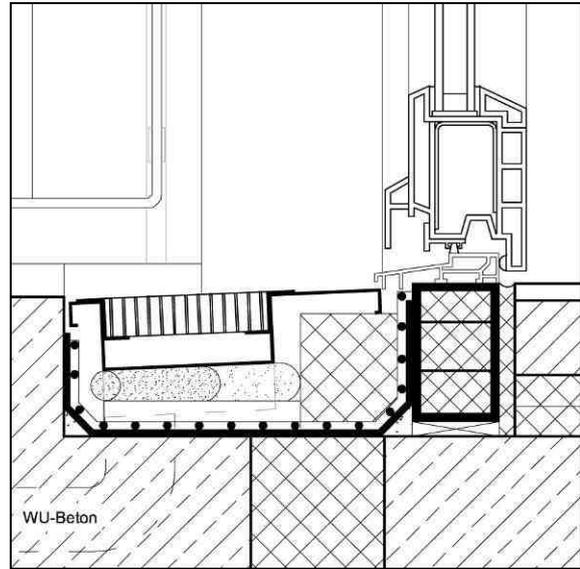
Detailschnitt Türschwelle Laubengang
